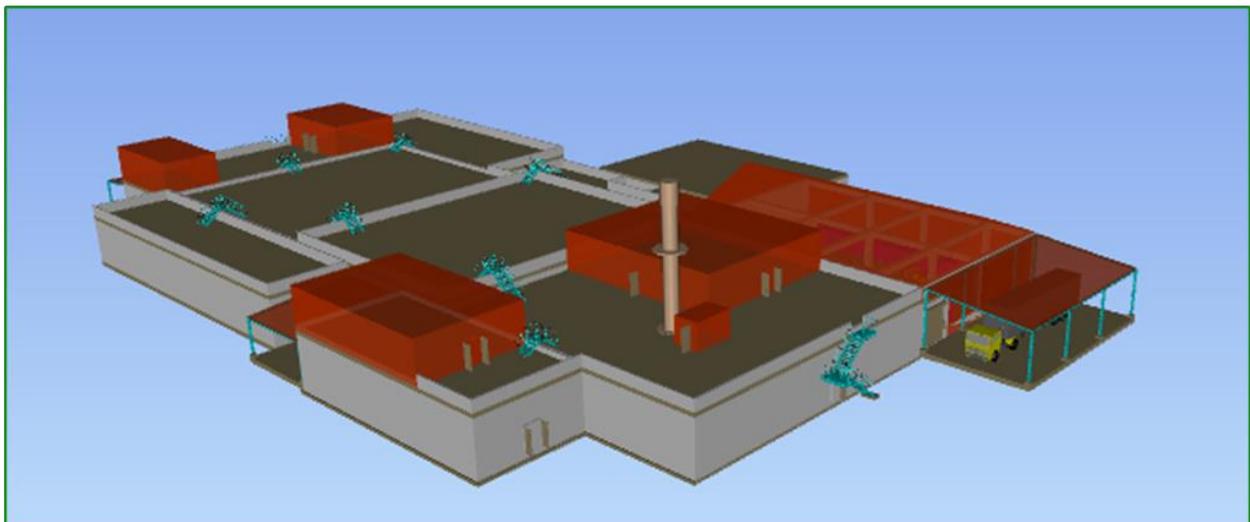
Emplacement de la cheminée de l'installation ATEF
